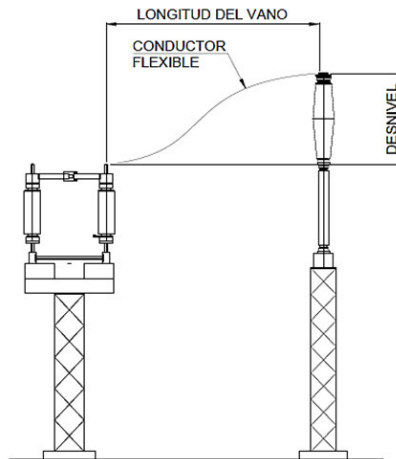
Esquema de conexionado entre equipos – Vista en corte
